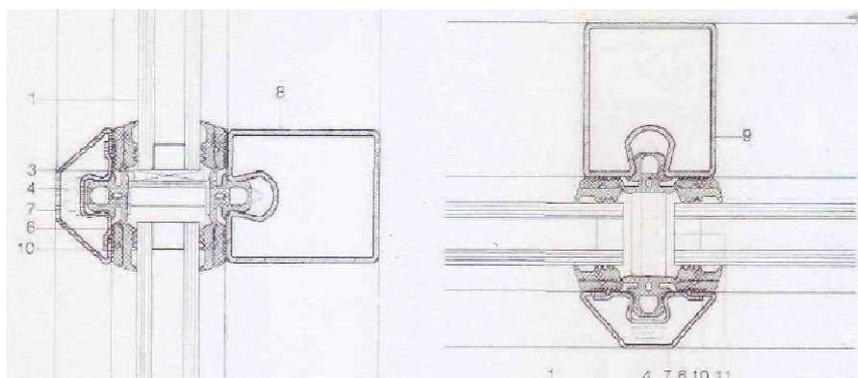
Telaio in acciaio con fermavetro di copertura
